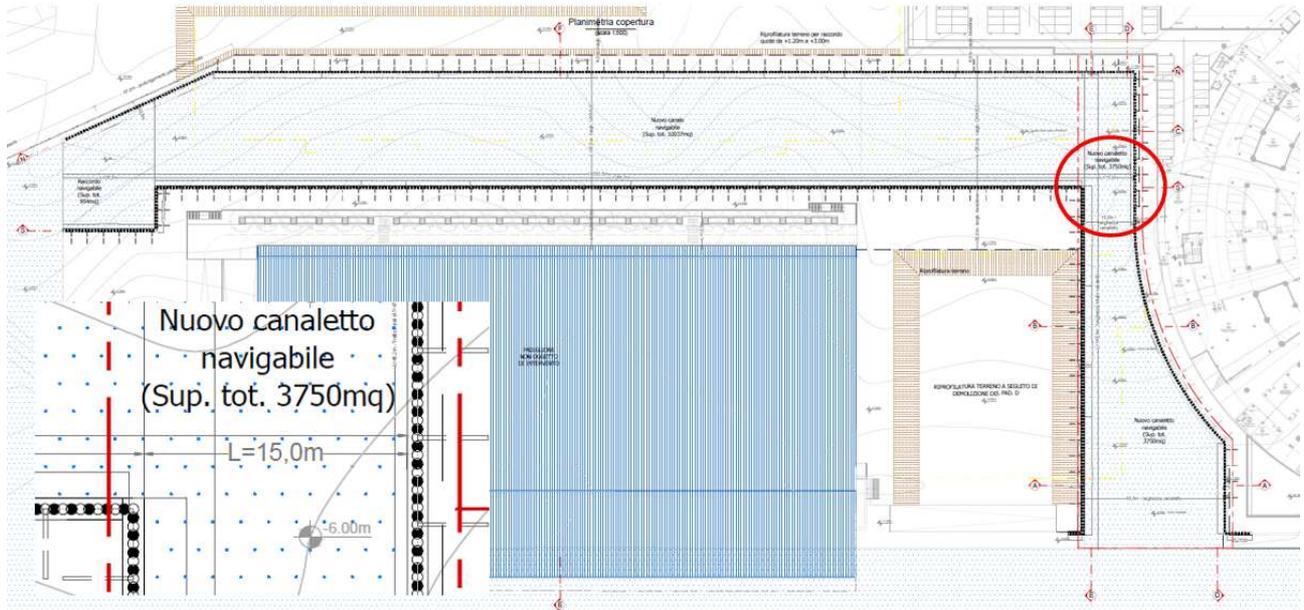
Sviluppo planimetrico delle paratie di pali secanti e dettaglio (stralcio tavola 01-D-St del Progetto Definitivo).
